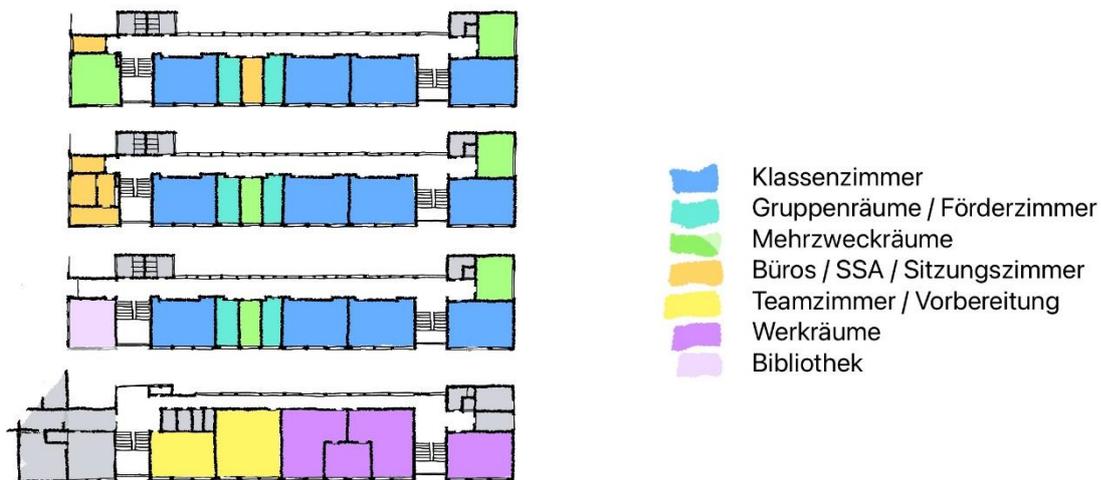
; Schema Neubau; 2. Obergeschoss / 1. Obergeschoss / Erdgeschoss / Untergeschoss
